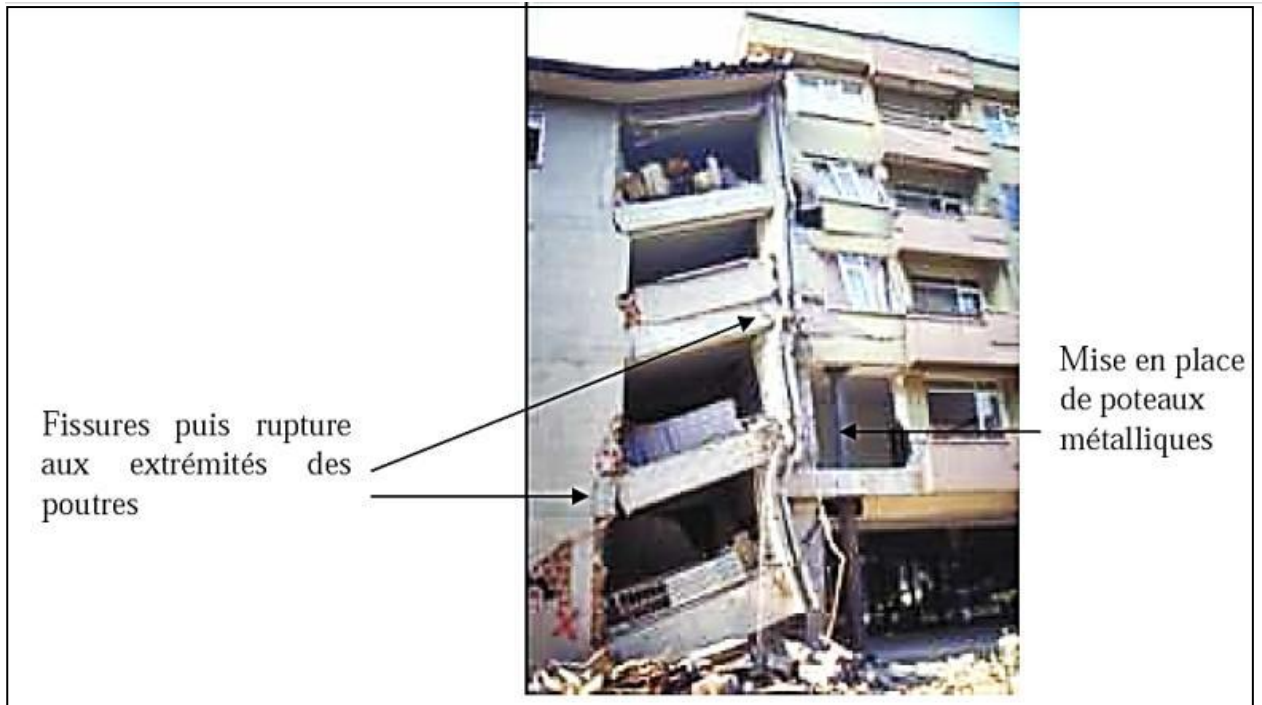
La destruction des éléments porteurs (poteaux ; poutres). Source : GARCIA JEAN-FRANÇOIS;2007.
